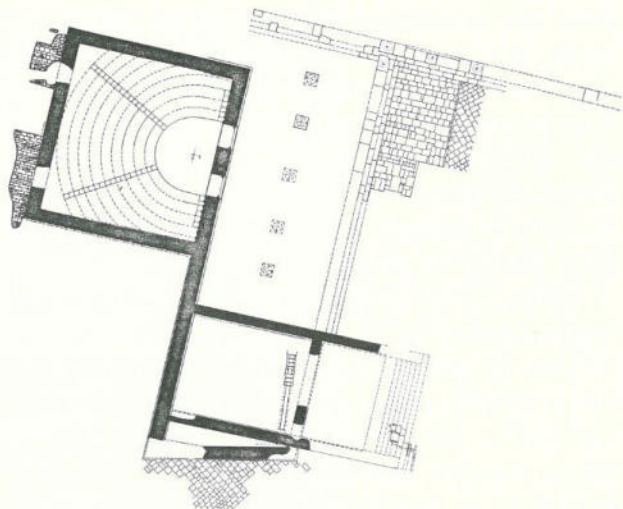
Lato ovest dell'agorà, pianta schematica 1984.
